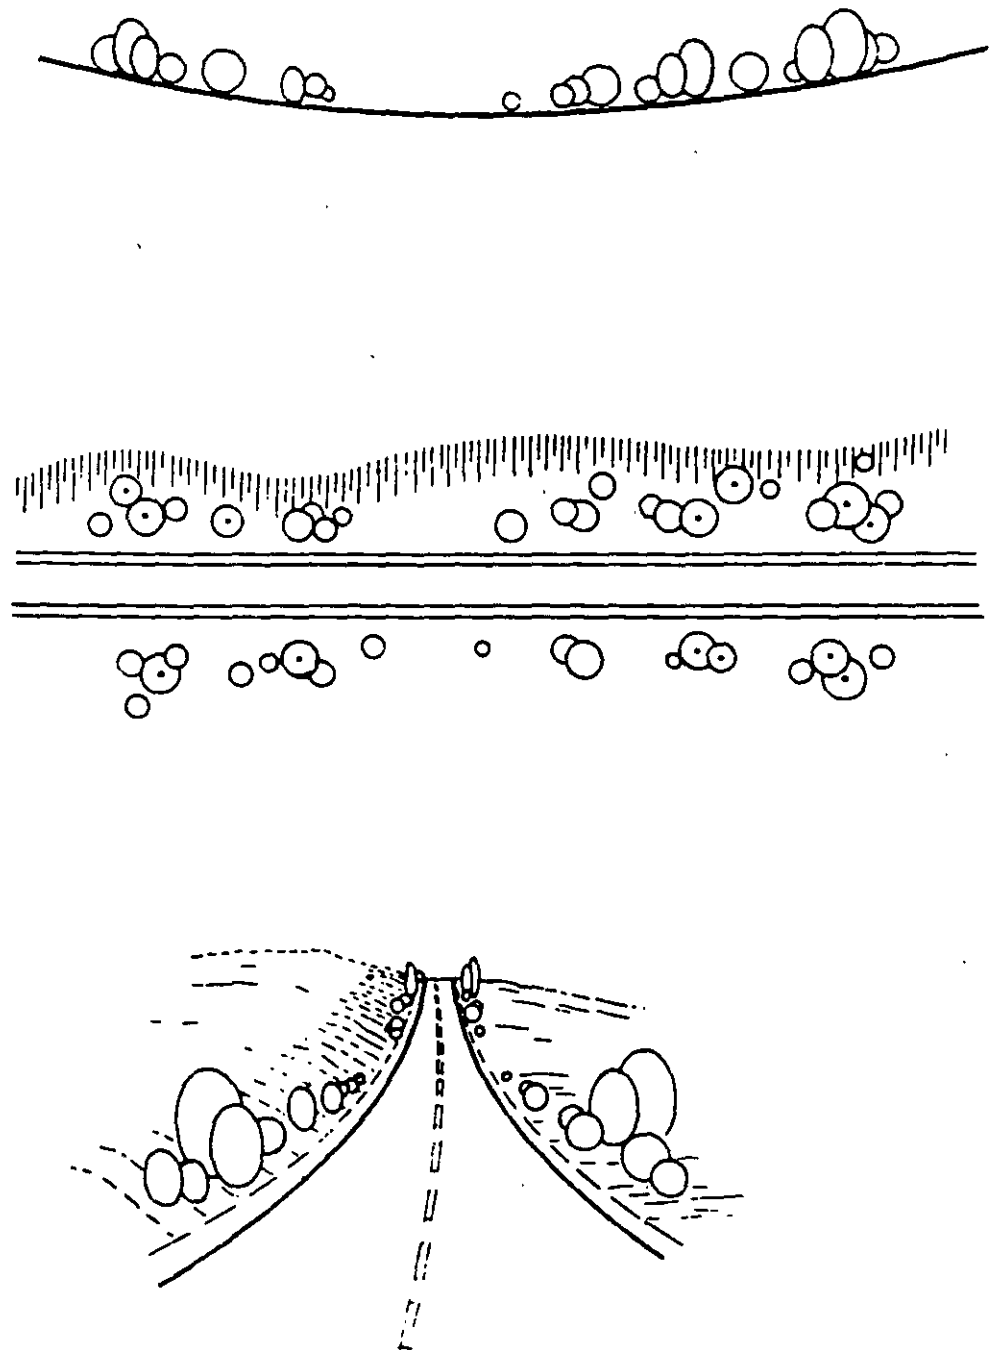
CRITERIO DE PLANTACION EN CURVA VERTICAL EN COLUMPIO
